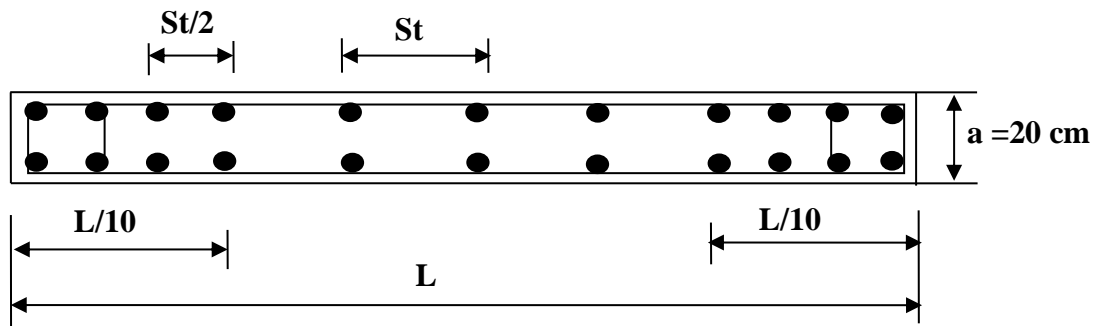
Disposition des armatures verticales dans les voiles.
